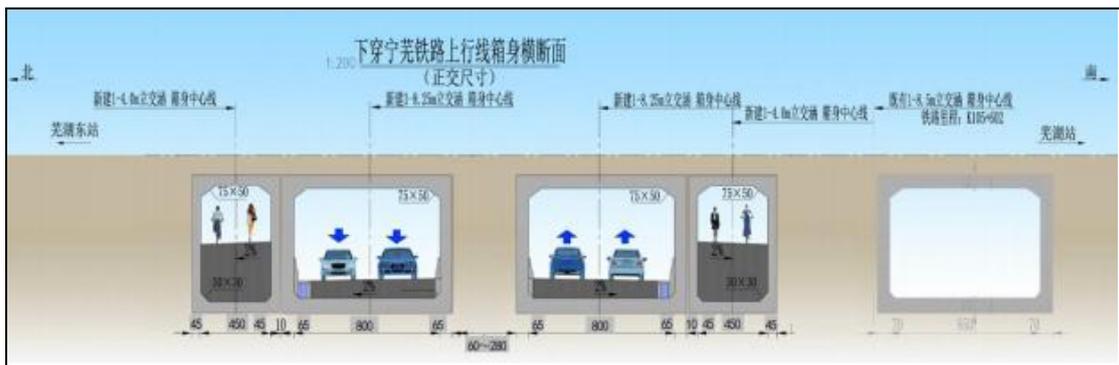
下穿宁芜铁路上行线横断面图
